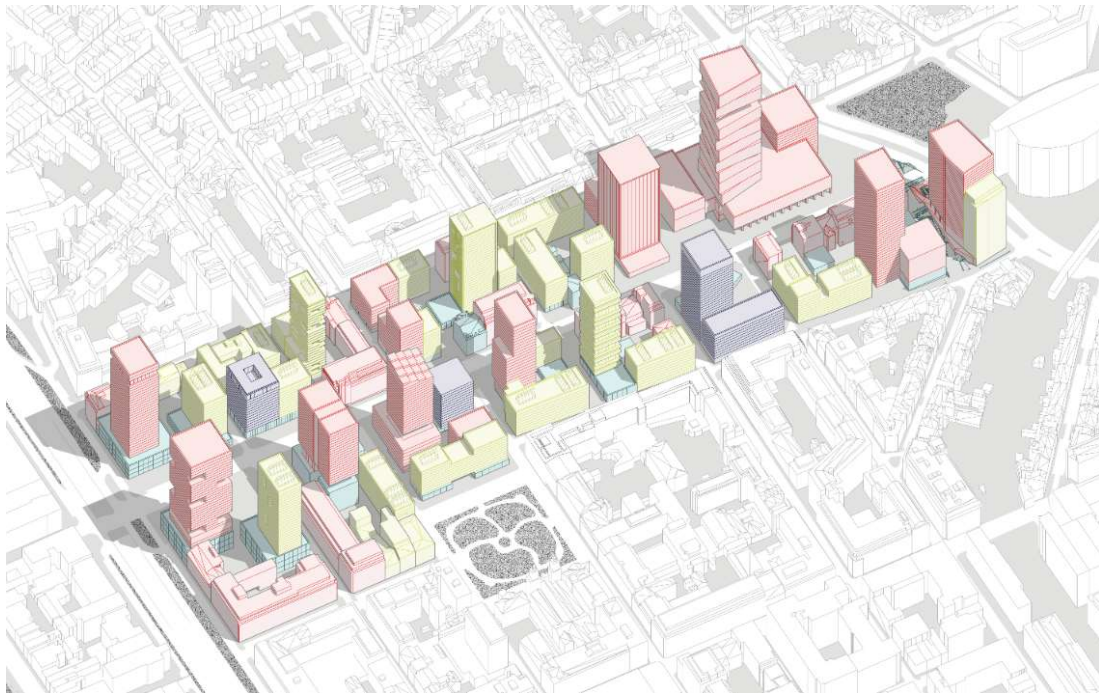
Exemple de traitement architectural possible pour l'alternative préférée (BUUR, 2018)
